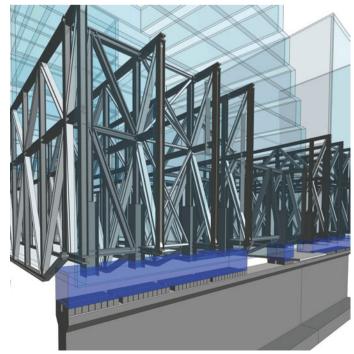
Projet ZAC Paris Rive gauche - Détail de la maquette représentant les appuis des poutres sur les sommiers en béton (en bleu sur la figure) posés sur des boîtes à ressorts reposant sur les voiles béton de la SNCF (l'enveloppe du bâtiment apparaît au-dessus des poutres) (© Egis).
